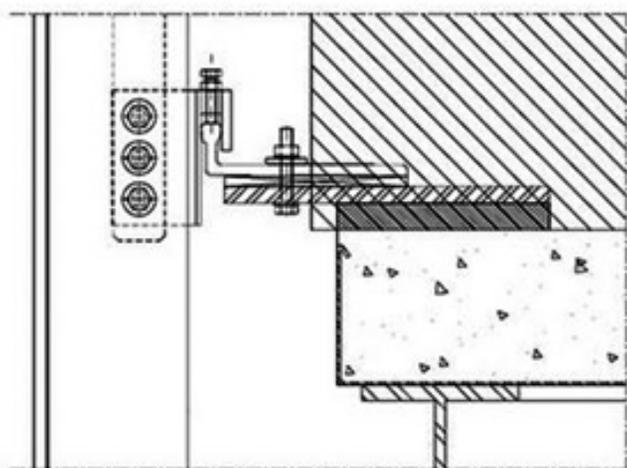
Viabilidade de uso do sistema Unitizado em edificações com estruturas metálicas e laje de concreto. (GELINSKI, 2013a)
